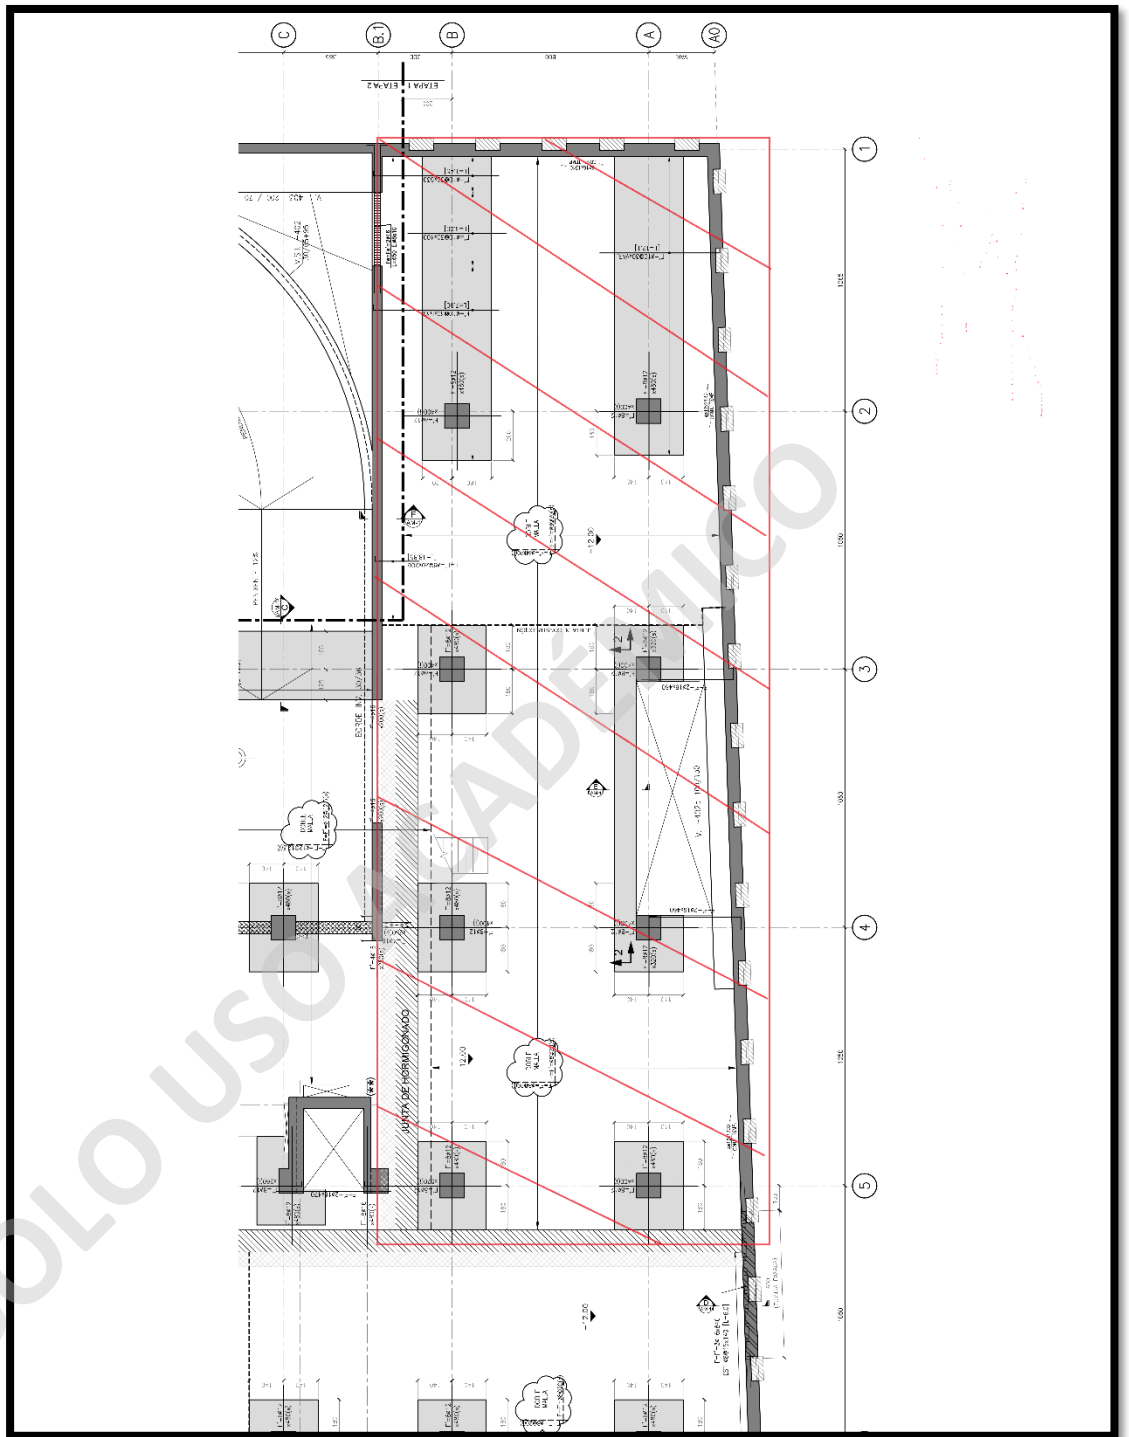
, Plano ejemplo, Fuente: Elaboración propia
